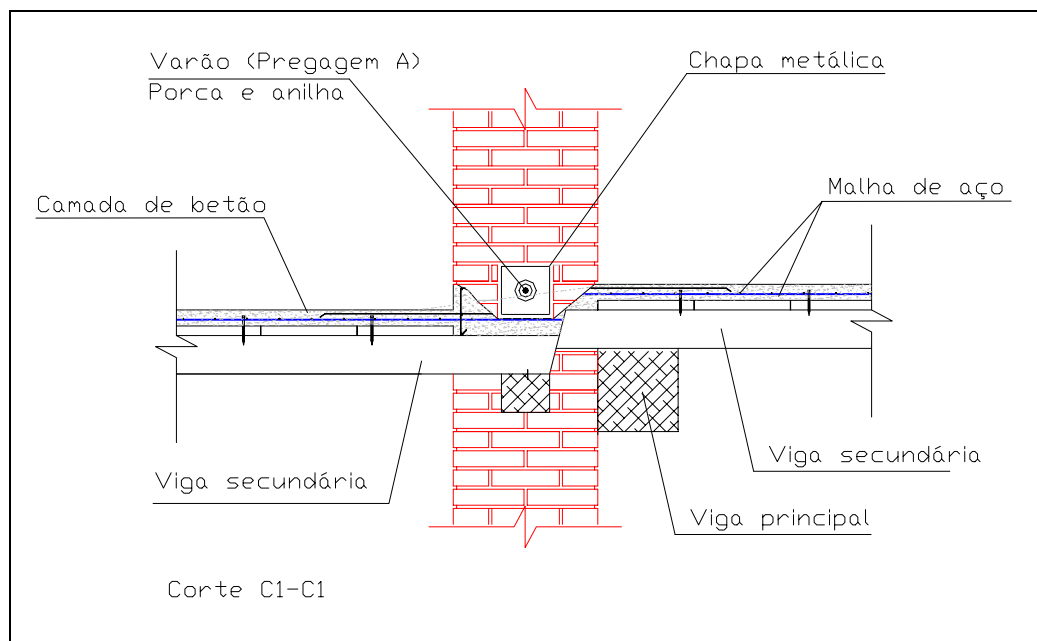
Ligação entre pavimentos e paredes de contraventamento. Ancoragem interior da pregagem A.
